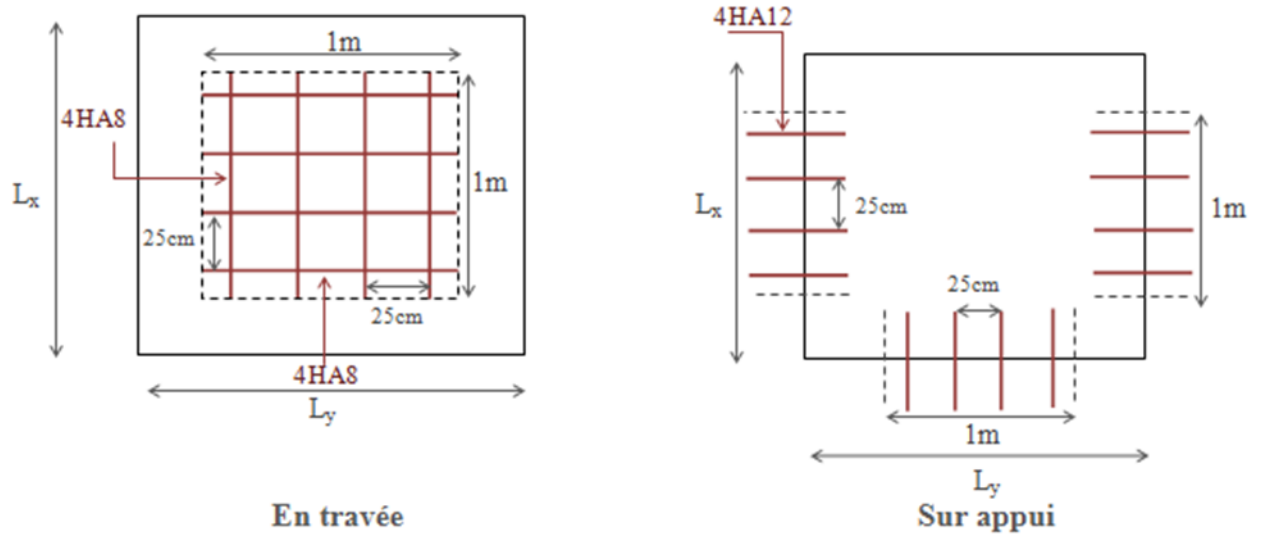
Ferrailage d'une bonde de 1 m du balcon étage
